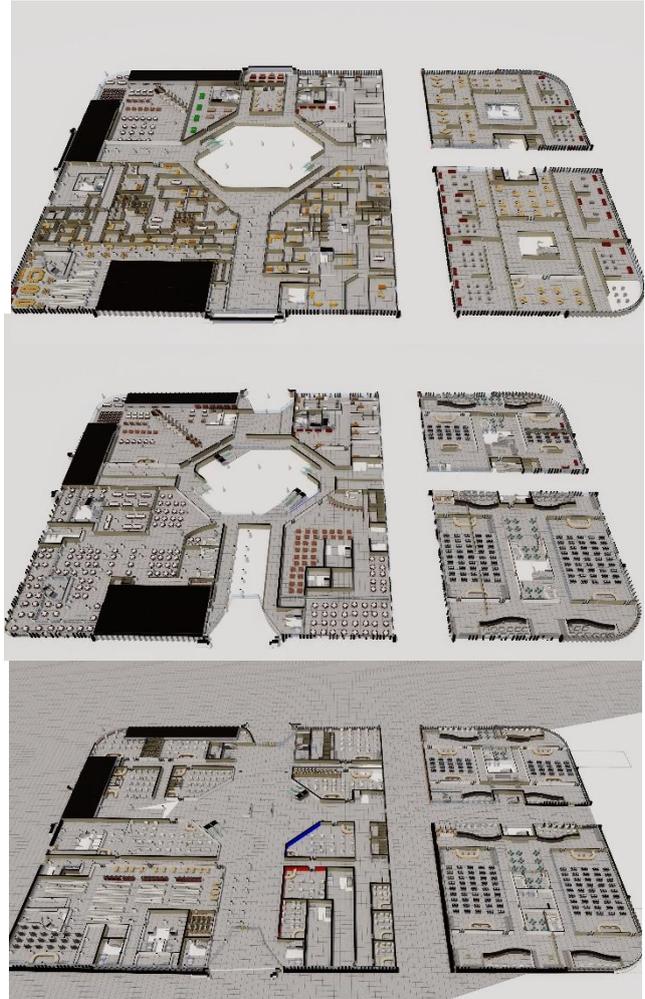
coupe perspective des plans du socle. Source : Travail d'auteur
